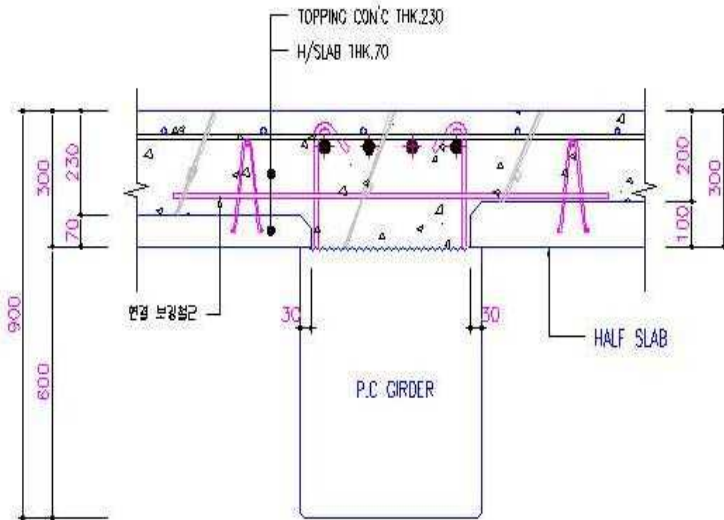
보(girder,beam)와 슬래브(half slab) 접합부
